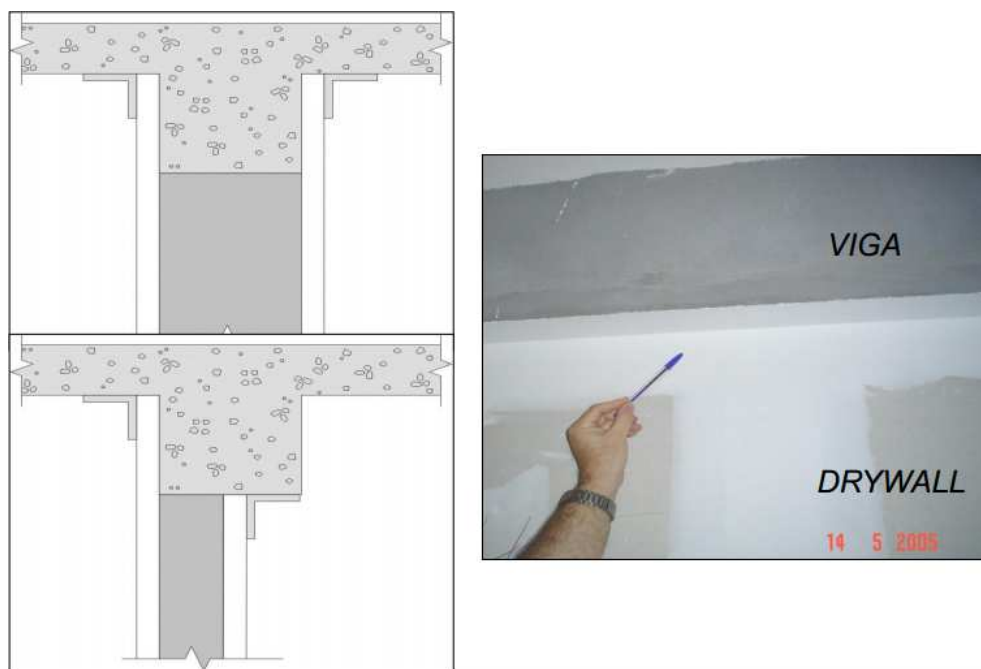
Tratamento de juntas indicado para evitar fissuração no encontro de pilares e Vigas (MITIDIERI, 2012)
